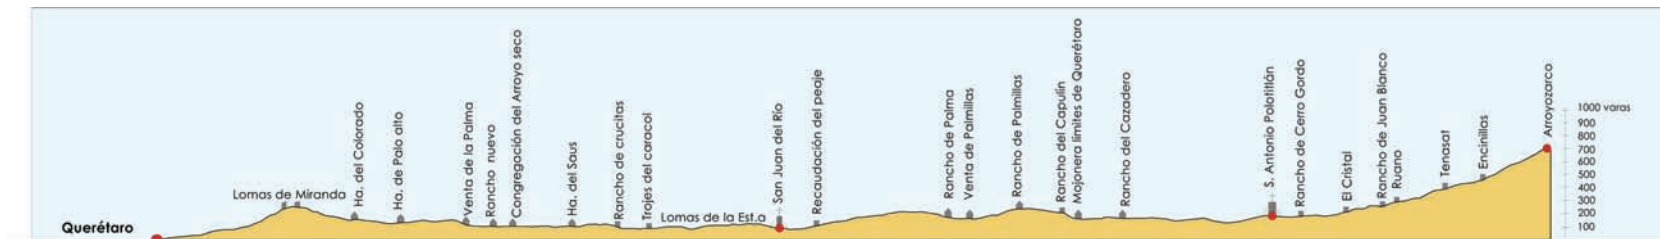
Corte esquemático del camino entre Arroyo Zarco y Querétaro, es una bajada constante. Fuente: Plano de Arroyo Zarco a Querétaro 1857. Secretaría de la Memoria del Estado.
